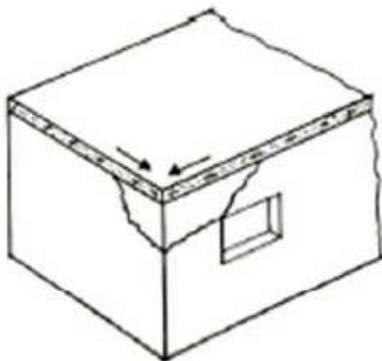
Fissuras que ocorrem numa laje de cobertura.
